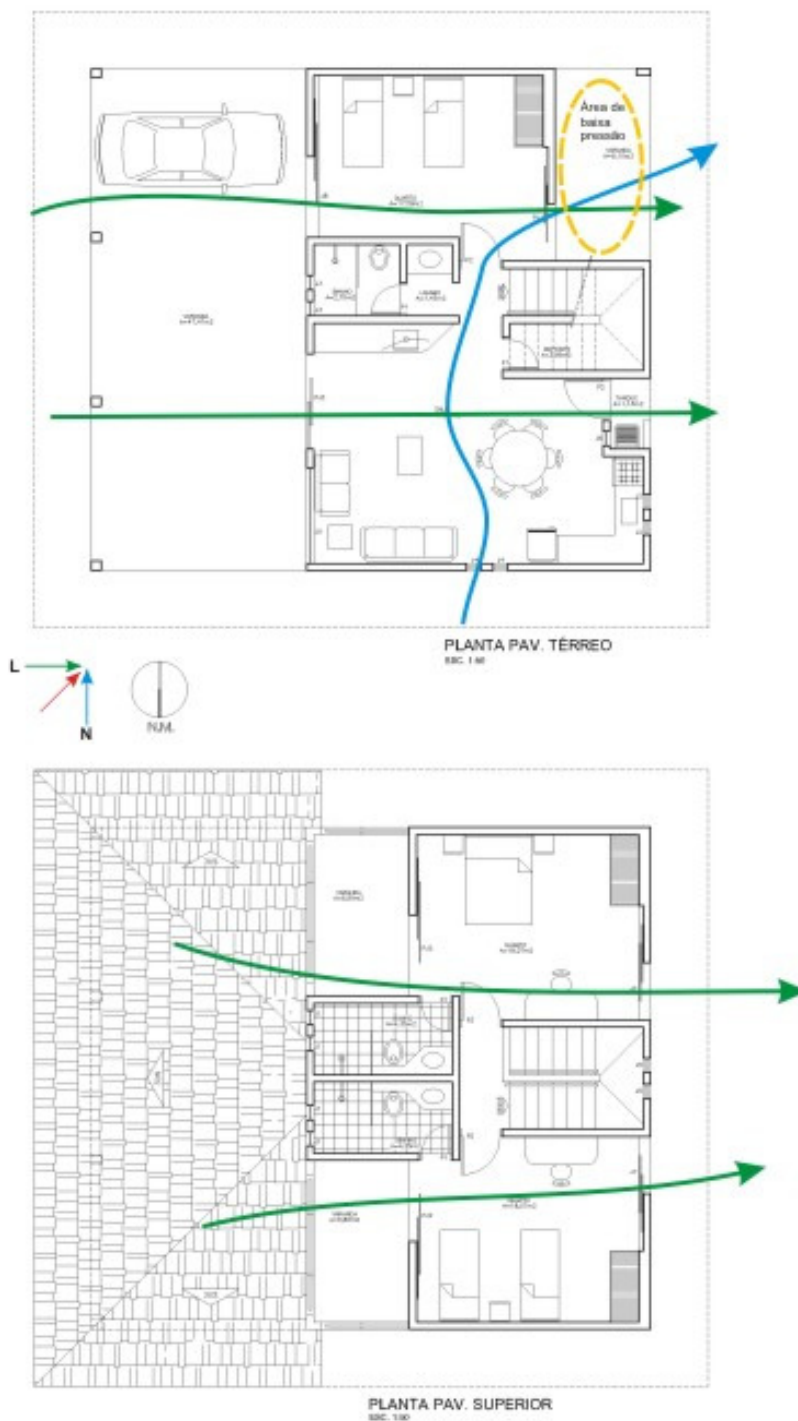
Projeto 4 – Ventilação Cruzada – Planta.
